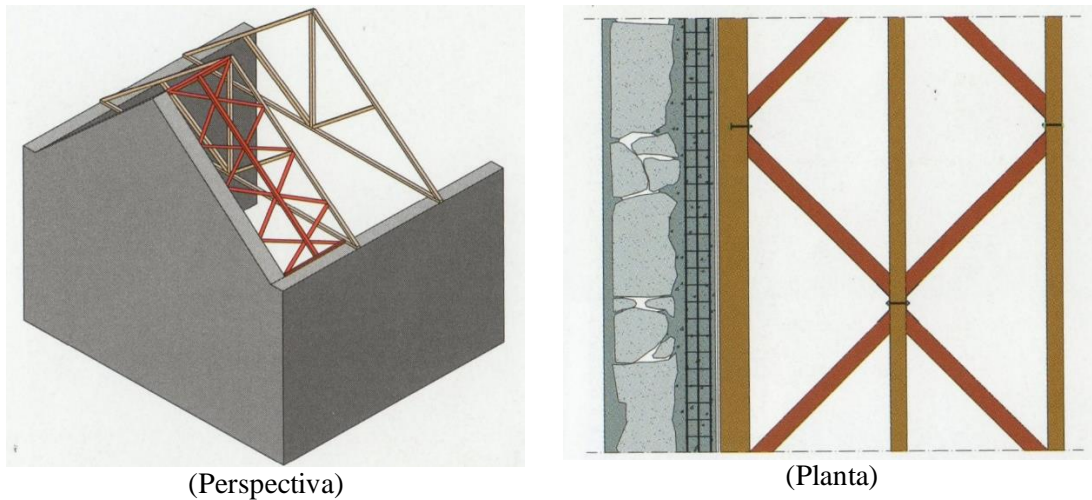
Reforço da cobertura e do apoio desta nas paredes de alvenaria, adaptado (Paisana dos Santos Lopes et al., 2008)
